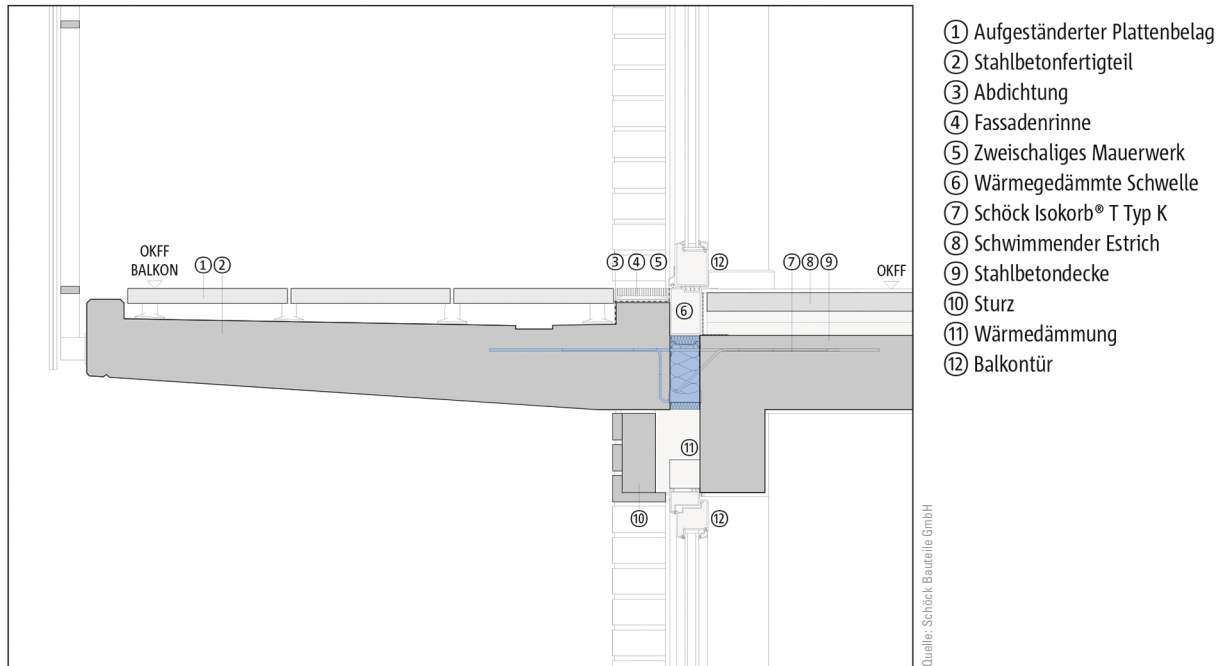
Anschluss frei auskragender Balkon an Stahlbetondecke mit Entwässerungsrichtung zum Gebäude
